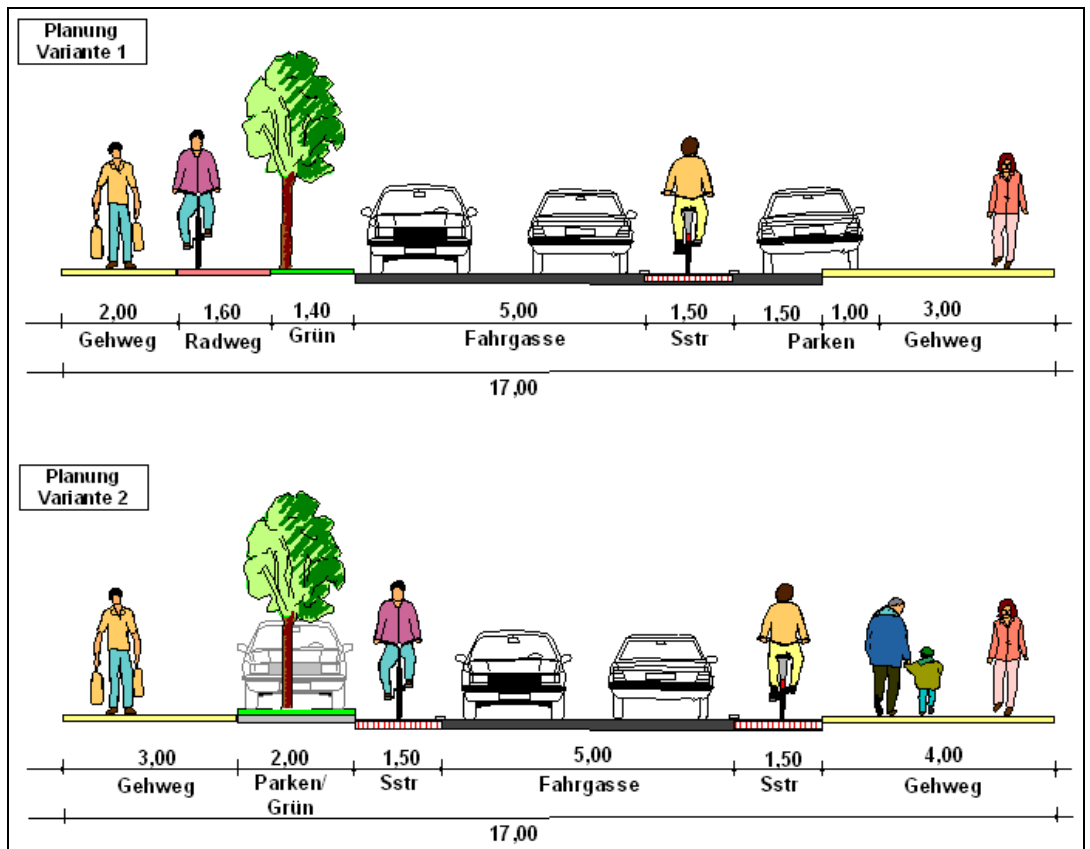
Elsassers Straße –Planungsvarianten in Abschnitt 1
